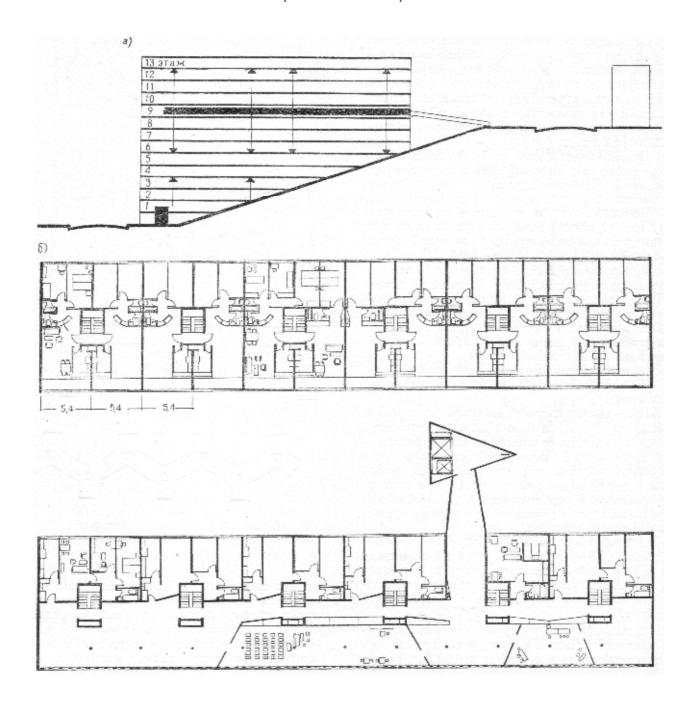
Примеры жилых домов секционного типа а — разрез жилого дома в комплексе Болье в Сент-Этьене (Франция); б — план типового и пятого этажей дома с помещениями общественного обслуживания (в квартале Ганза, Западный Берлин)
